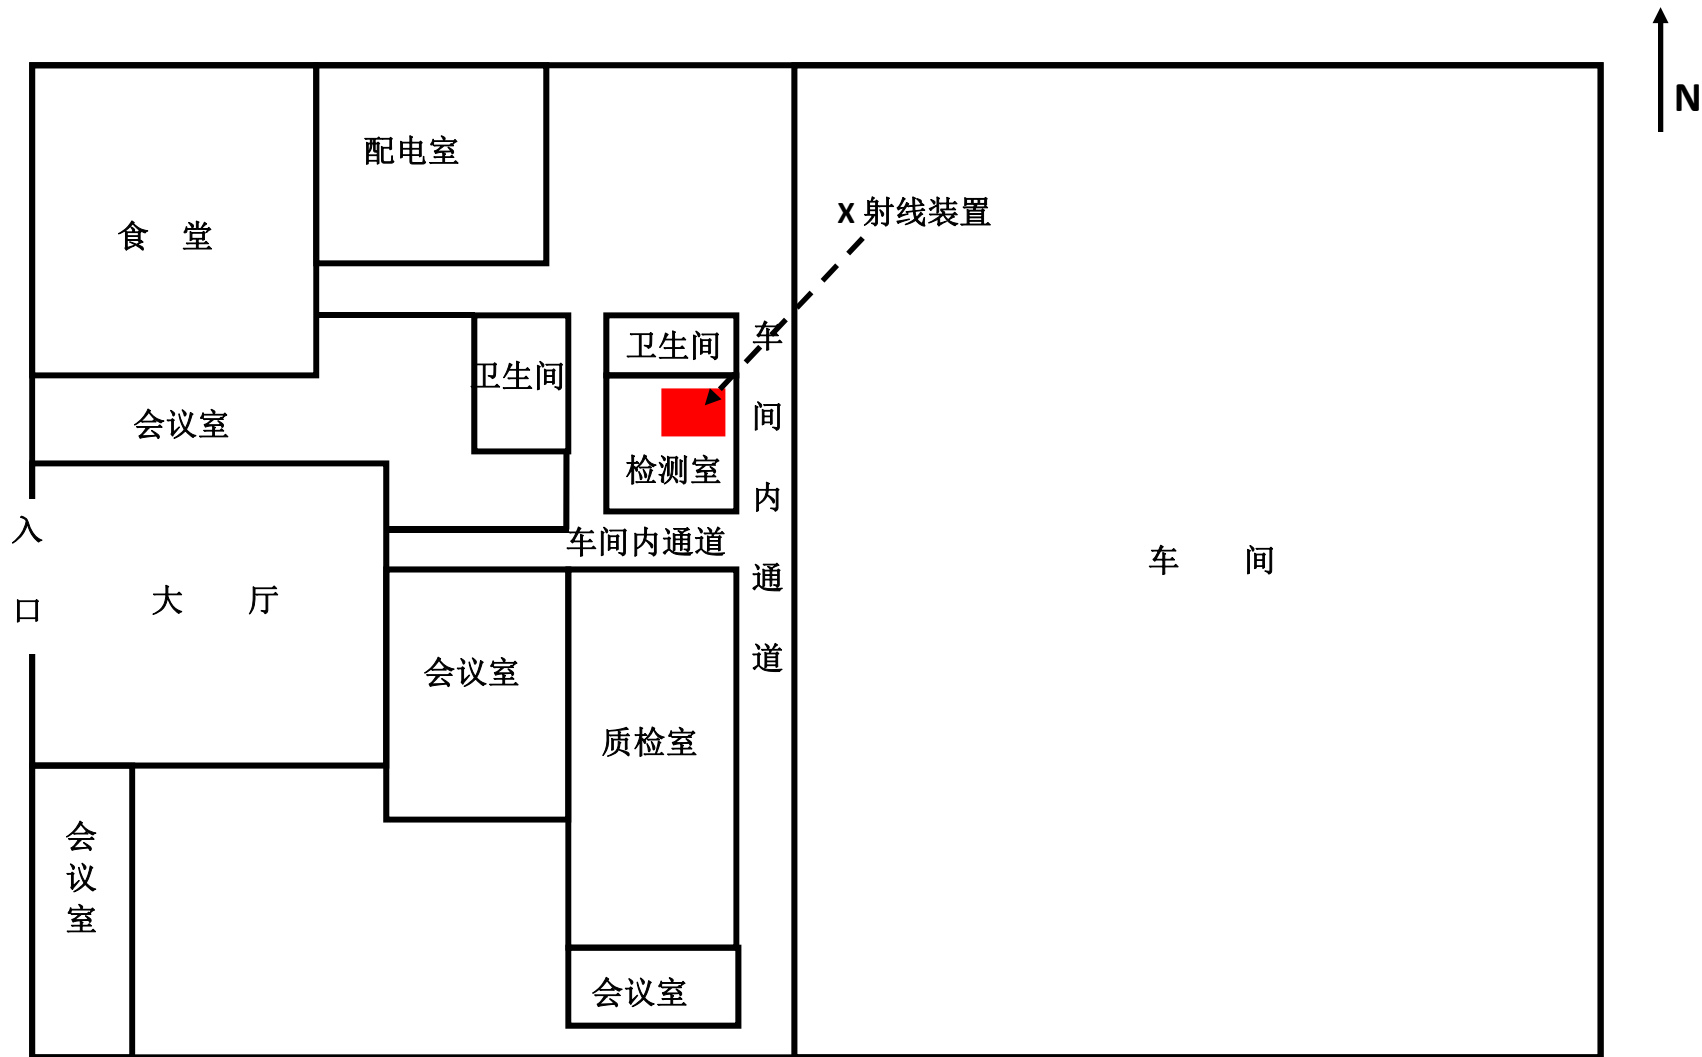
厂区平面布置及X射线装置安装位置示意图（一层）
